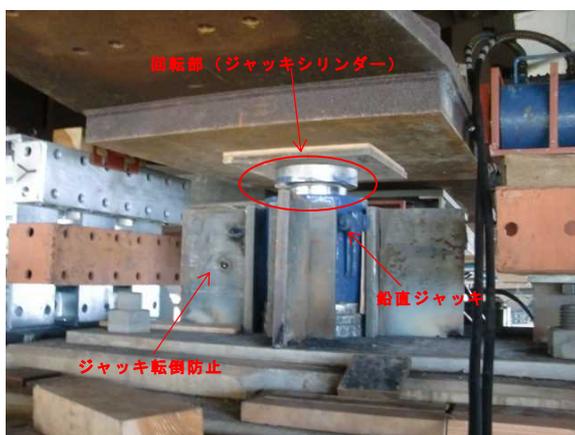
P1-G2橋脚部桁移動設備（回転中心部）
